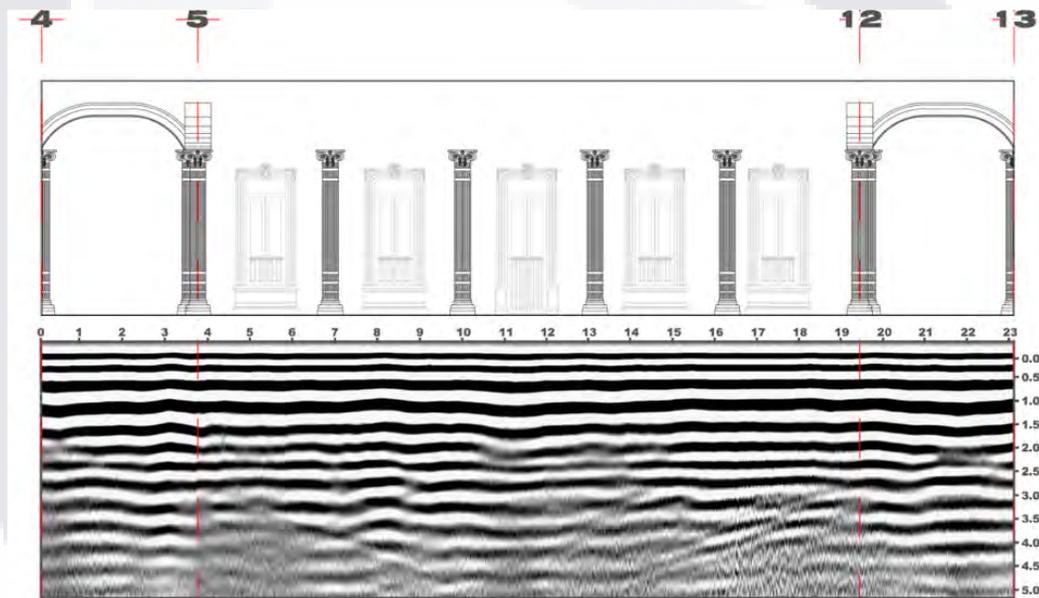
Alzado pasillo transversal del museo y perfil GPR-6. Fuente: Elaboración propia.
